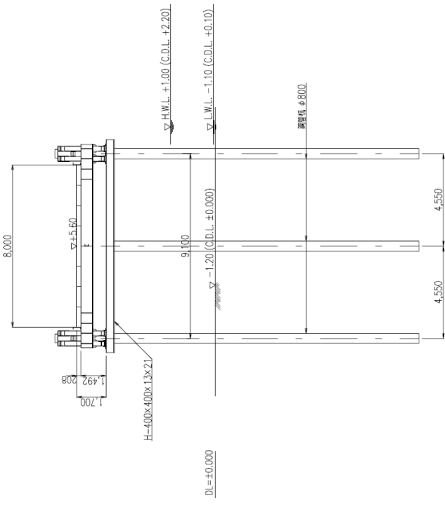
(5) 工事用仮設道路縦断面図 (C-2 区間)
